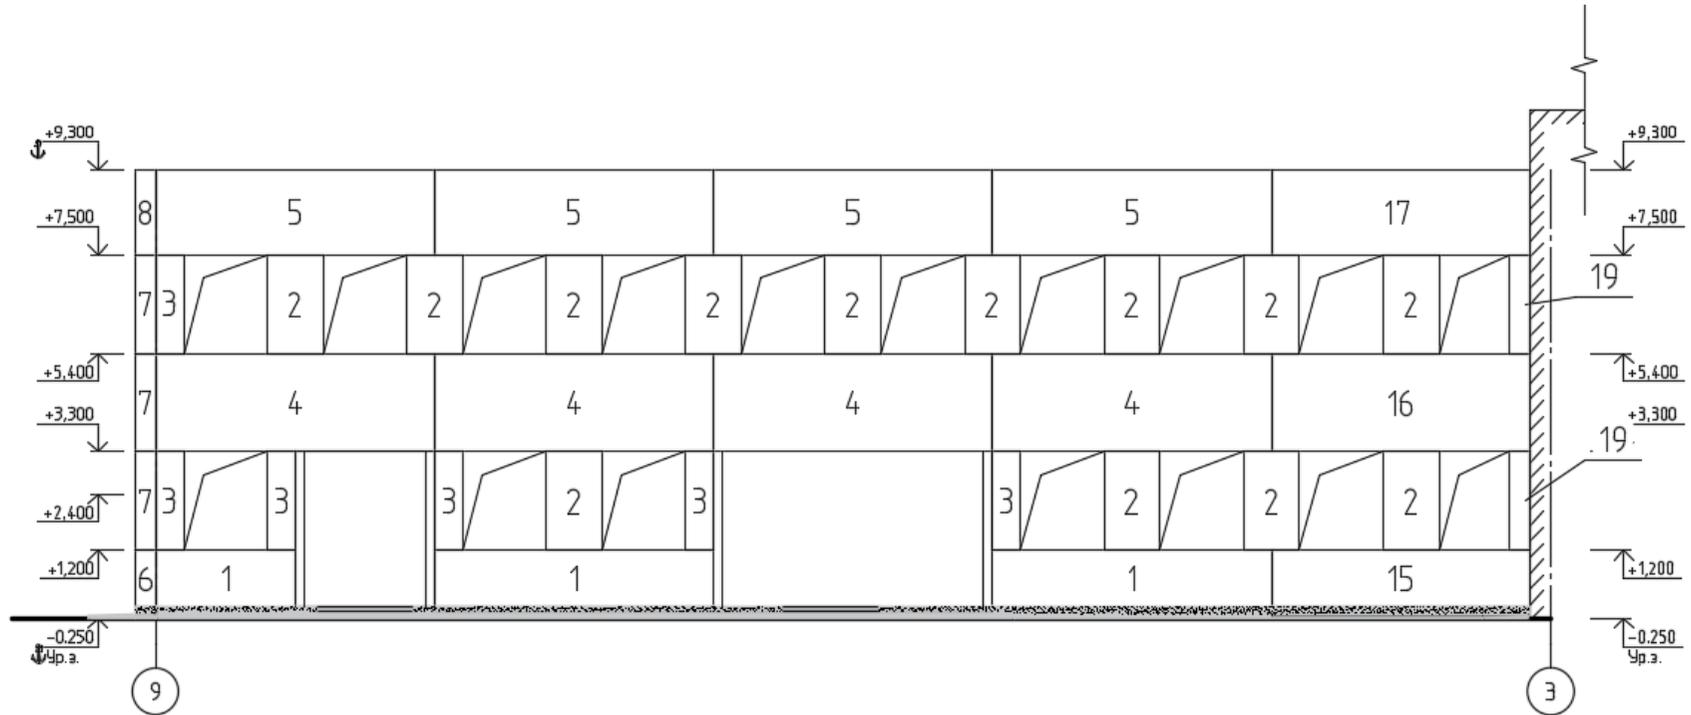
Схема расположения стеновых панелей на фасаде 9-3
